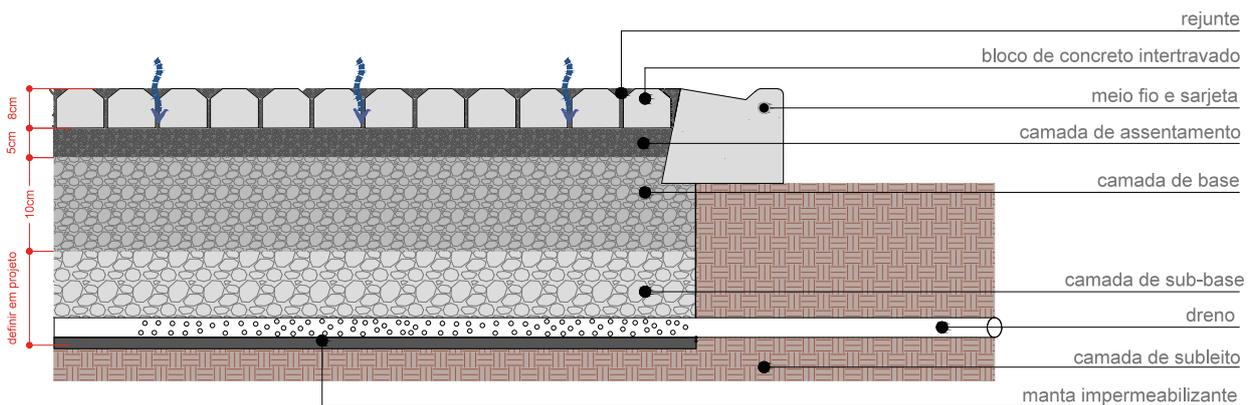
Esquema técnico de pavimento intertravado sem infiltração no solo.
